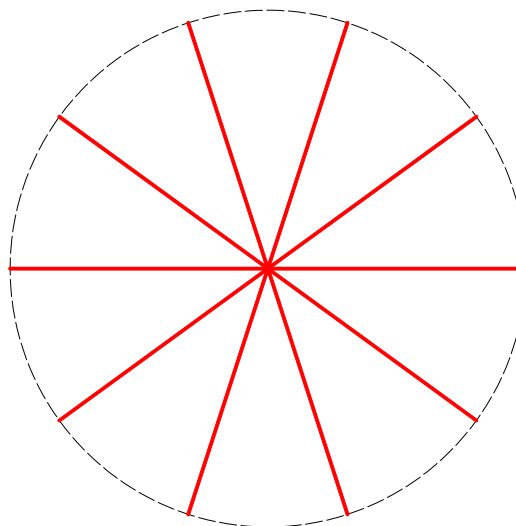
Esquema da disposição das asnas da cobertura em planta
